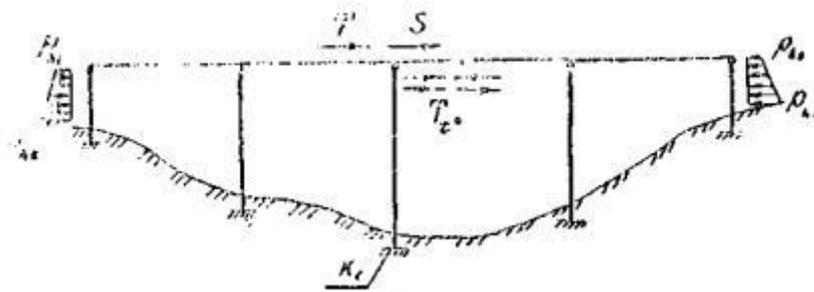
Пример расчетной схемы рамной промежуточной опоры (обозначения см. рис. 9.2.1)
